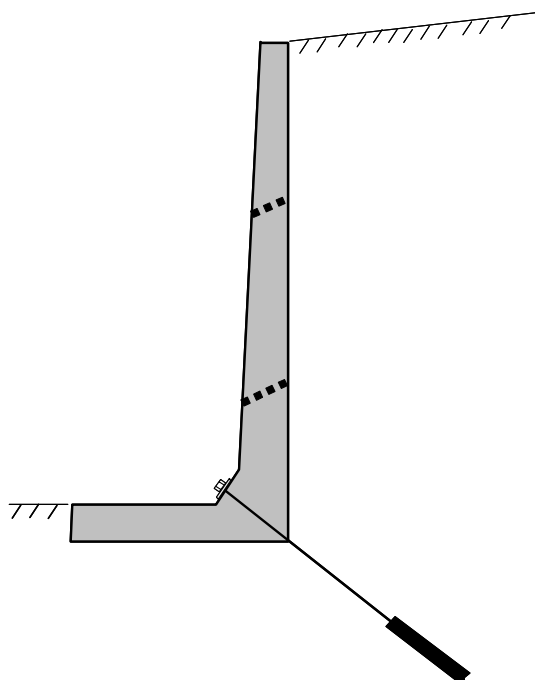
Muro in cemento armato (a mensola con sezione ad L) con base tirantata; in tratteggio i dreni del muro; i tiranti sono descritti tra le strutture di rinforzo interno (interventi D1a) -
